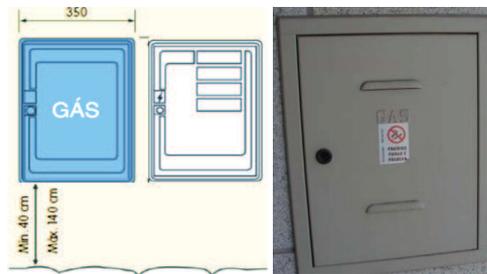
Instalação de Caixas de Corte Geral [44]
